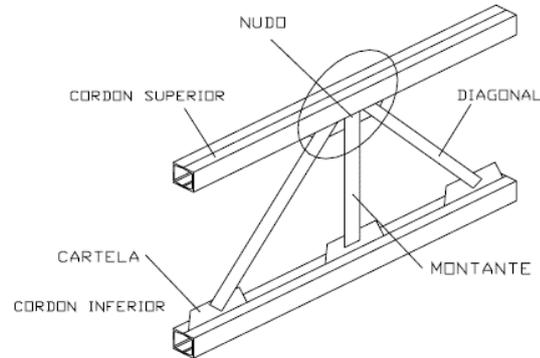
Elementos de una viga reticulada. Fuente: Brotons (2010)
